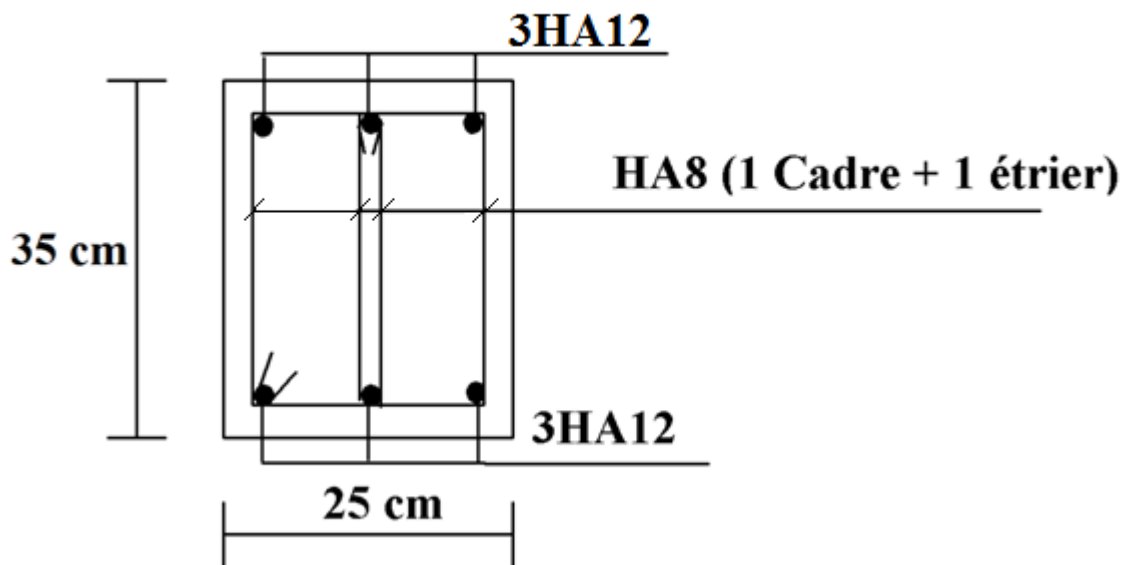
Coupe horizontale A-A de la poutre de chaînage
